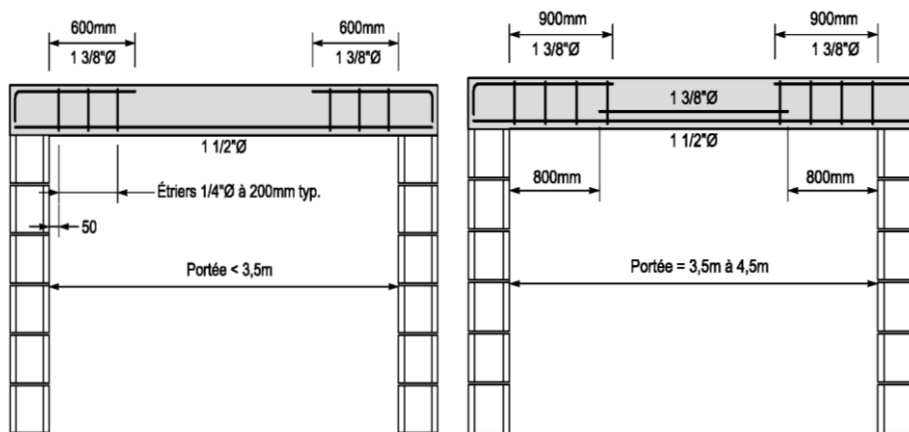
Armature des poutrelles de portée simple dans une dalle alvéolée de 200 mm d'épaisseur
